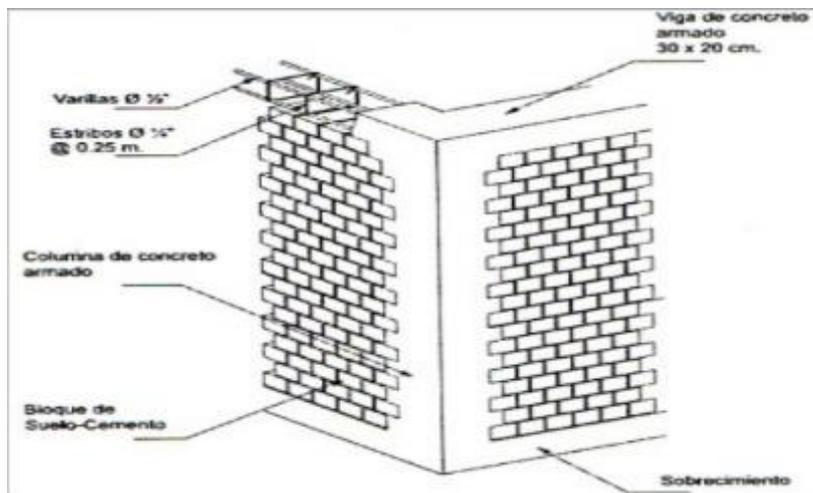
Detalle de albañilería y sus elementos de confinamiento
